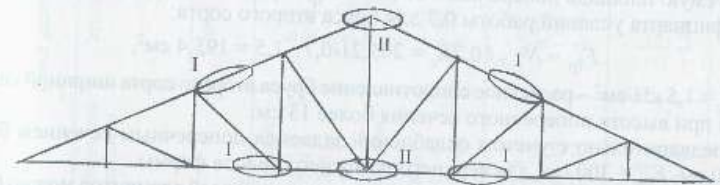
Схема и варианты расположения стыков верхнего и нижнего поясов фермы
